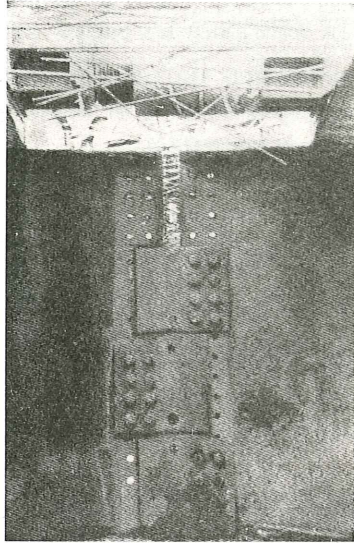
Detalle de la junta provisional del puente de la figura 27, antes del pretensado.
